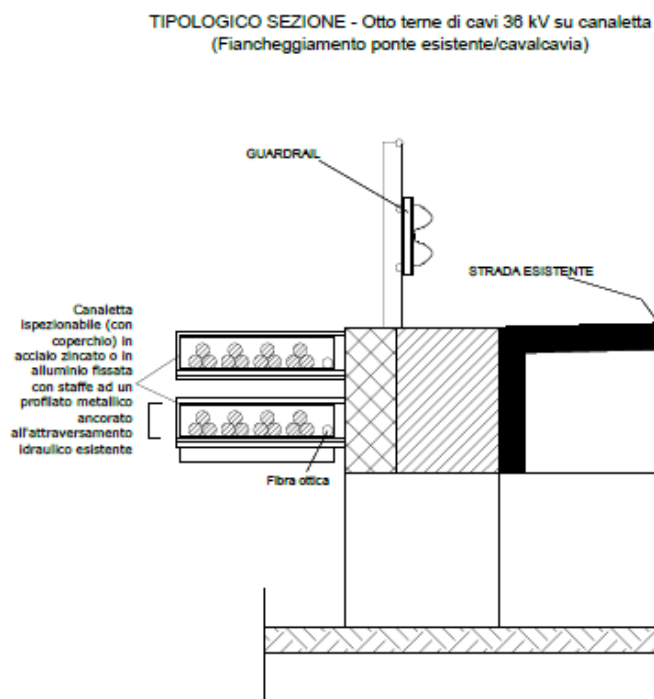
Sezione trasversale cavidotto AT in fiancheggiamento al ponte o cavalcavia.
